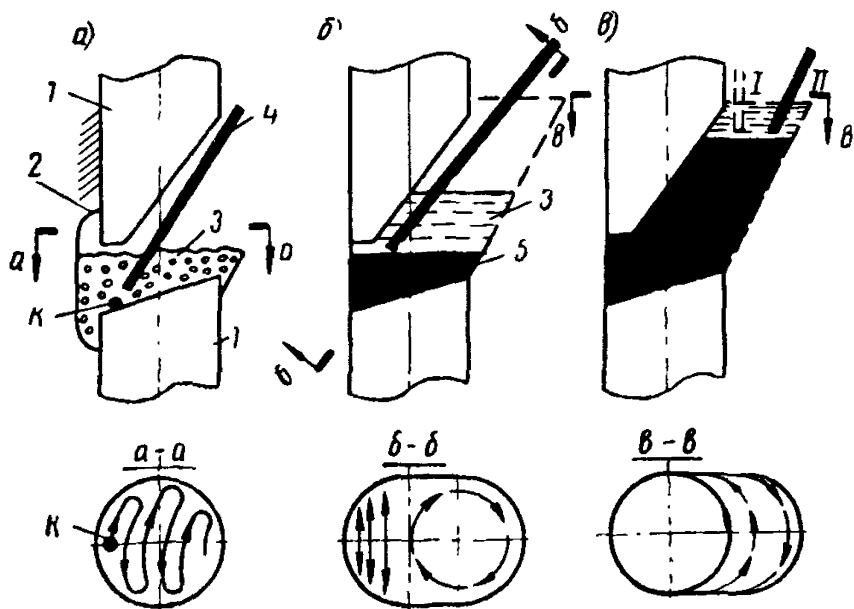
Техника полуавтоматической ванный дуговой сварки стыковых соединений вертикальных стержней диаметром > 32 мм
